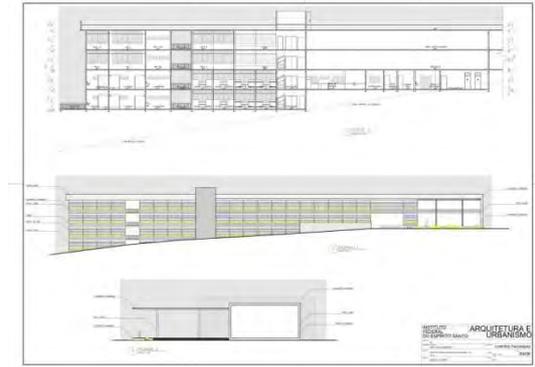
Representação técnica finalizada: Plantas, cortes, fachada e perspectivas.
